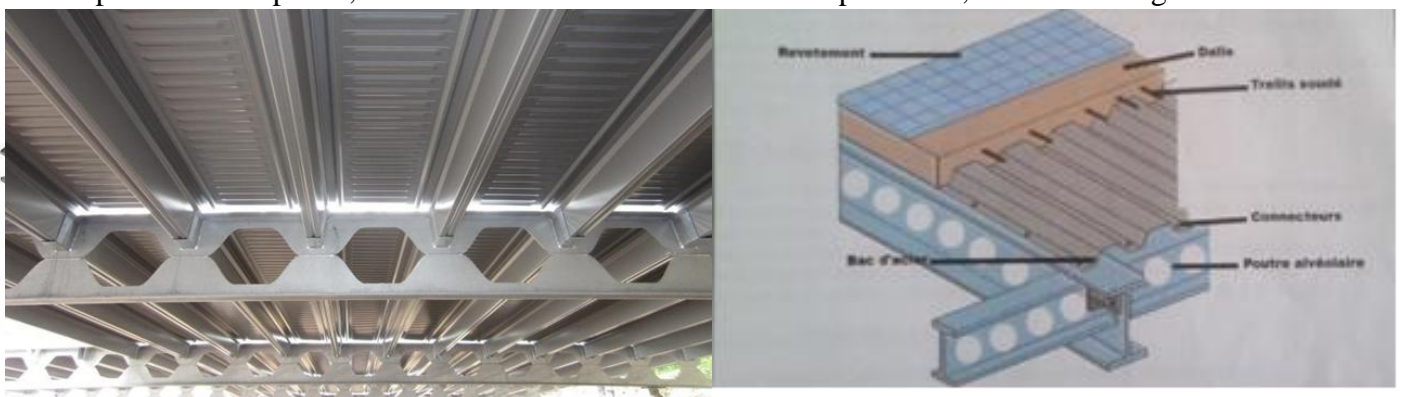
Assemblage poutre alvéolaire avec plancher collaborant
